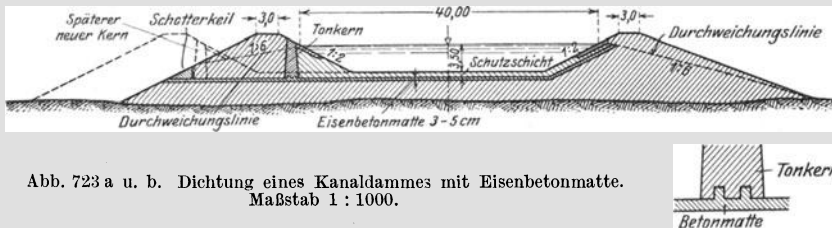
a u. b. Dichtung eines Kanaldammes mit Eisenbetonmatte.
